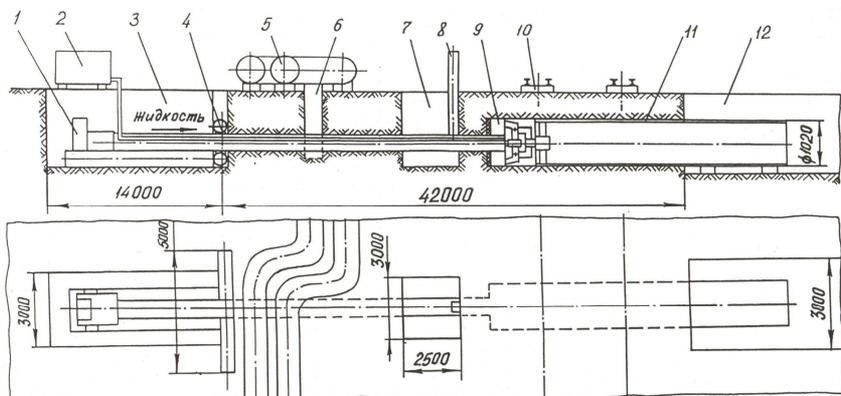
Схема проведения горизонтальной скважины для газопровода в г.Новокузнецке: 1 - буровая установка; 2 - емкость в жидкость; 3 - рабочий котлован; 4 - якорь; 5 - теплотрасса; 6 - бетонная опора; 7 - промежуточный котлован; 8 - свая; 9 - расширитель обратного хода; 10 - железнодорожный путь; 11 - кожух; 12 - приемный котлован
